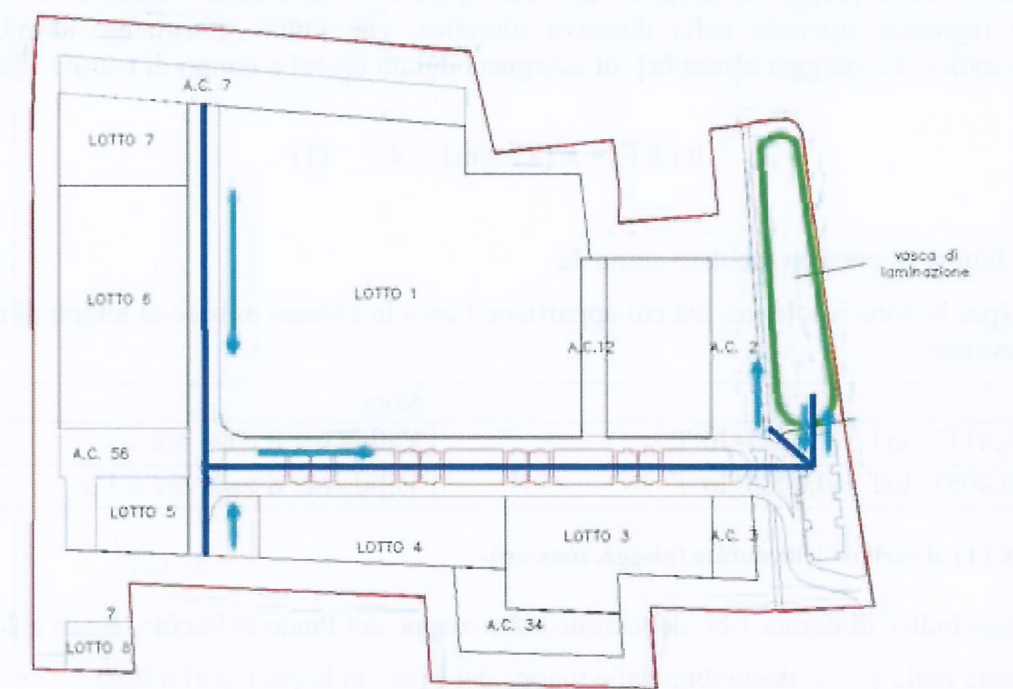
schema concettuale della rete di drenaggio per l'area edificata allo studio
